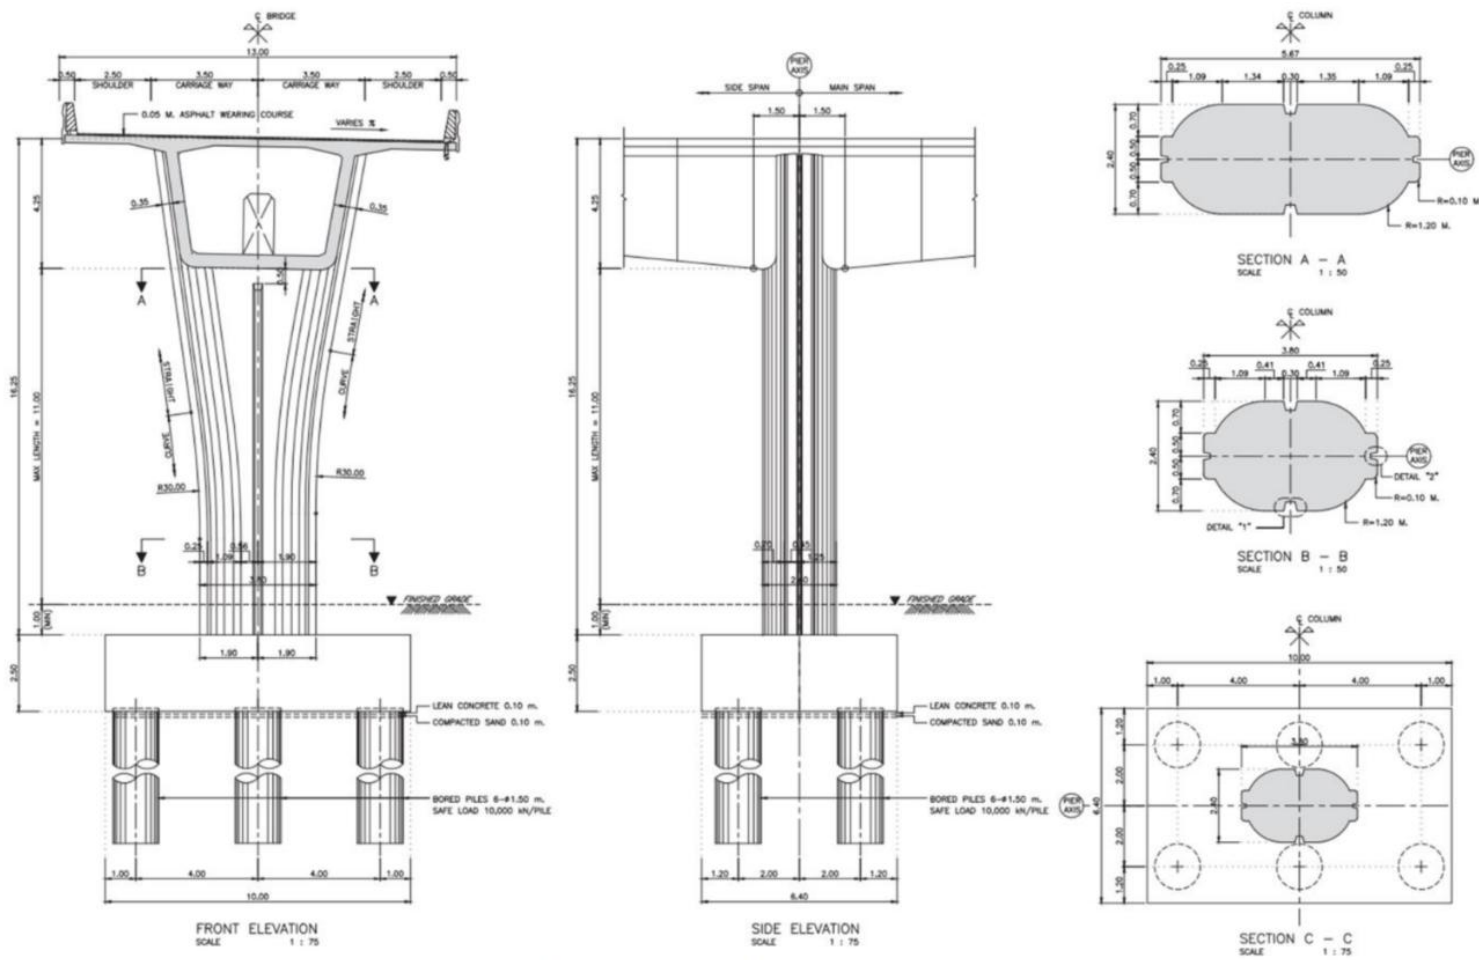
(ต่อ) รายละเอียดแบบฐานราก Pre-cast Segmental Concrete Box Girder
